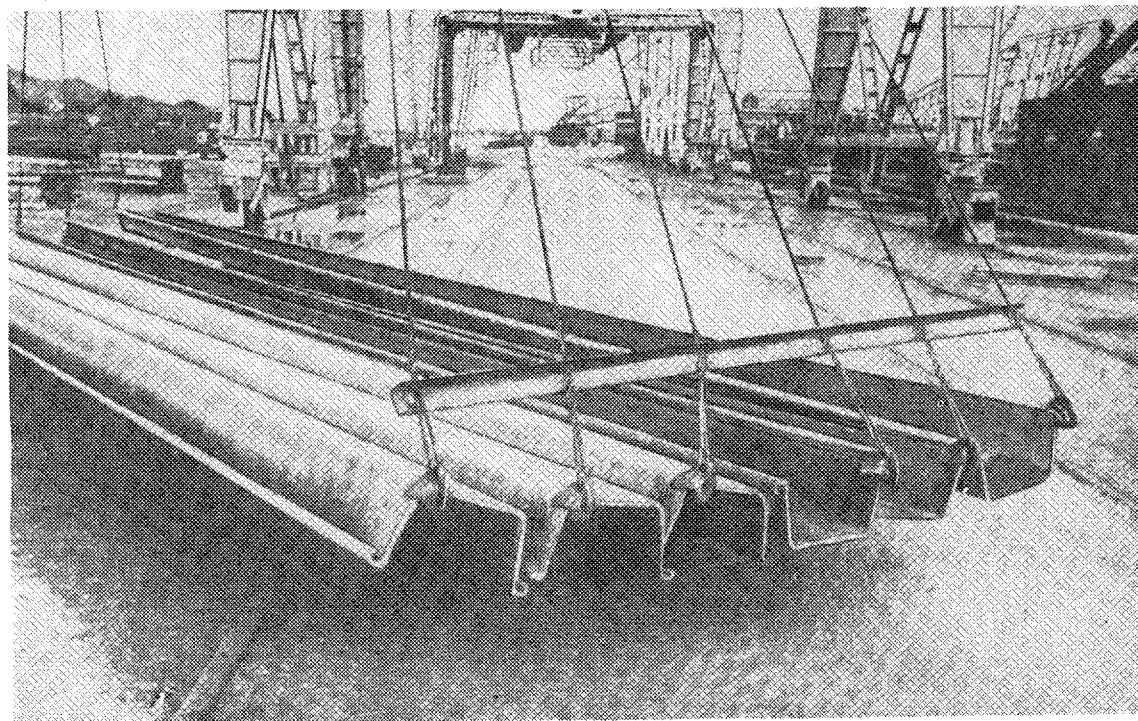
Поштучная перегрузка шпунтовых свай с помощью крановой подвески с захватами. Порт Ильичевск
